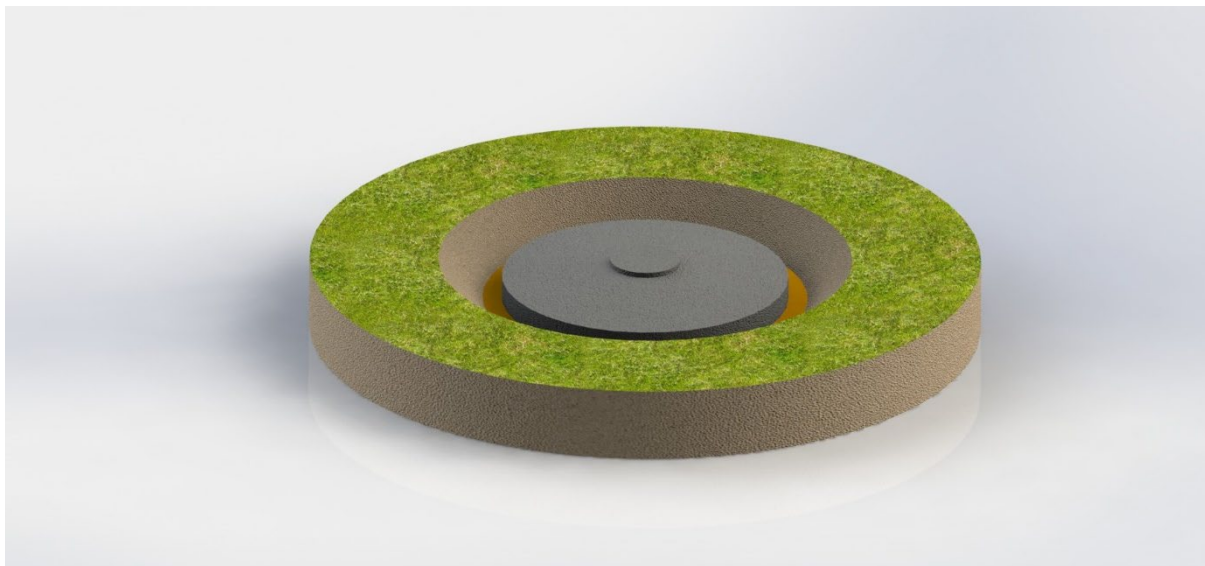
Tipologia plinto di fondazione-Vista 3D
